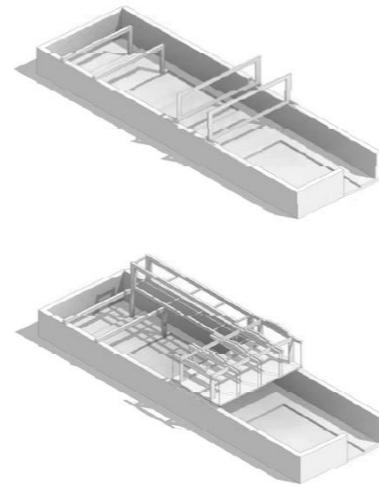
Sistema estructural / Fuente:Análisis de las Características Estructurales en la Obra del Gabinete de Arquitectura y Propuesta Arquitectónica
